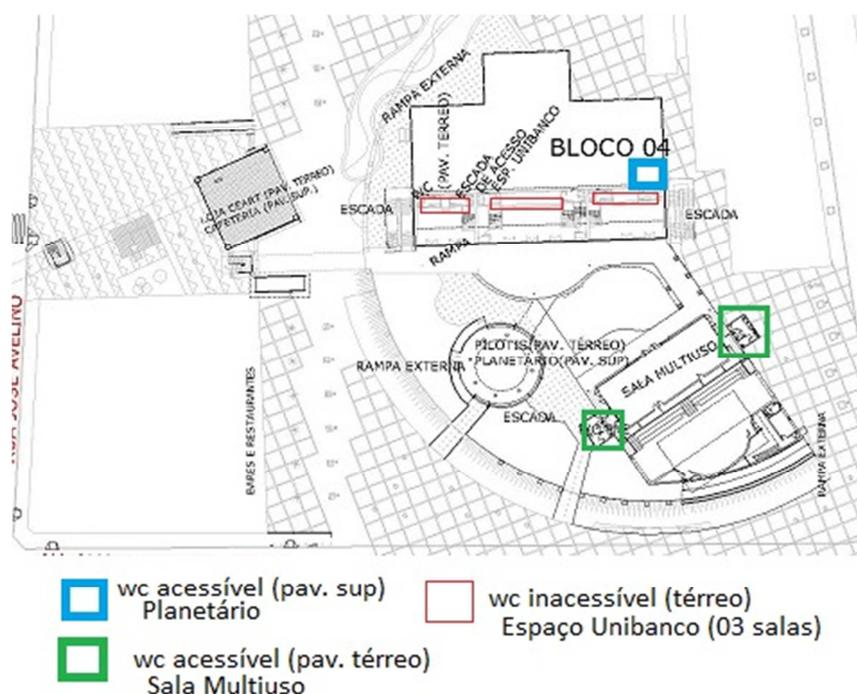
Planta baixa do bloco 04 com marcação dos sanitários existentes.
